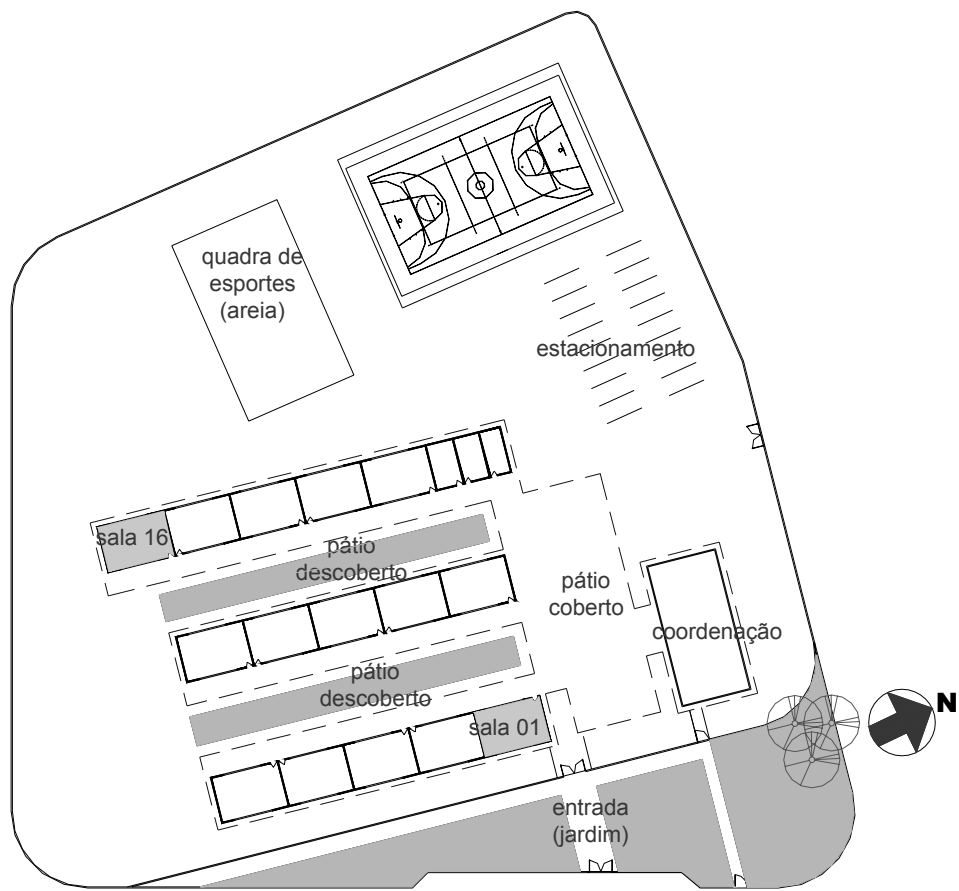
Planta esquemática da Escola Aníbal Difrância
